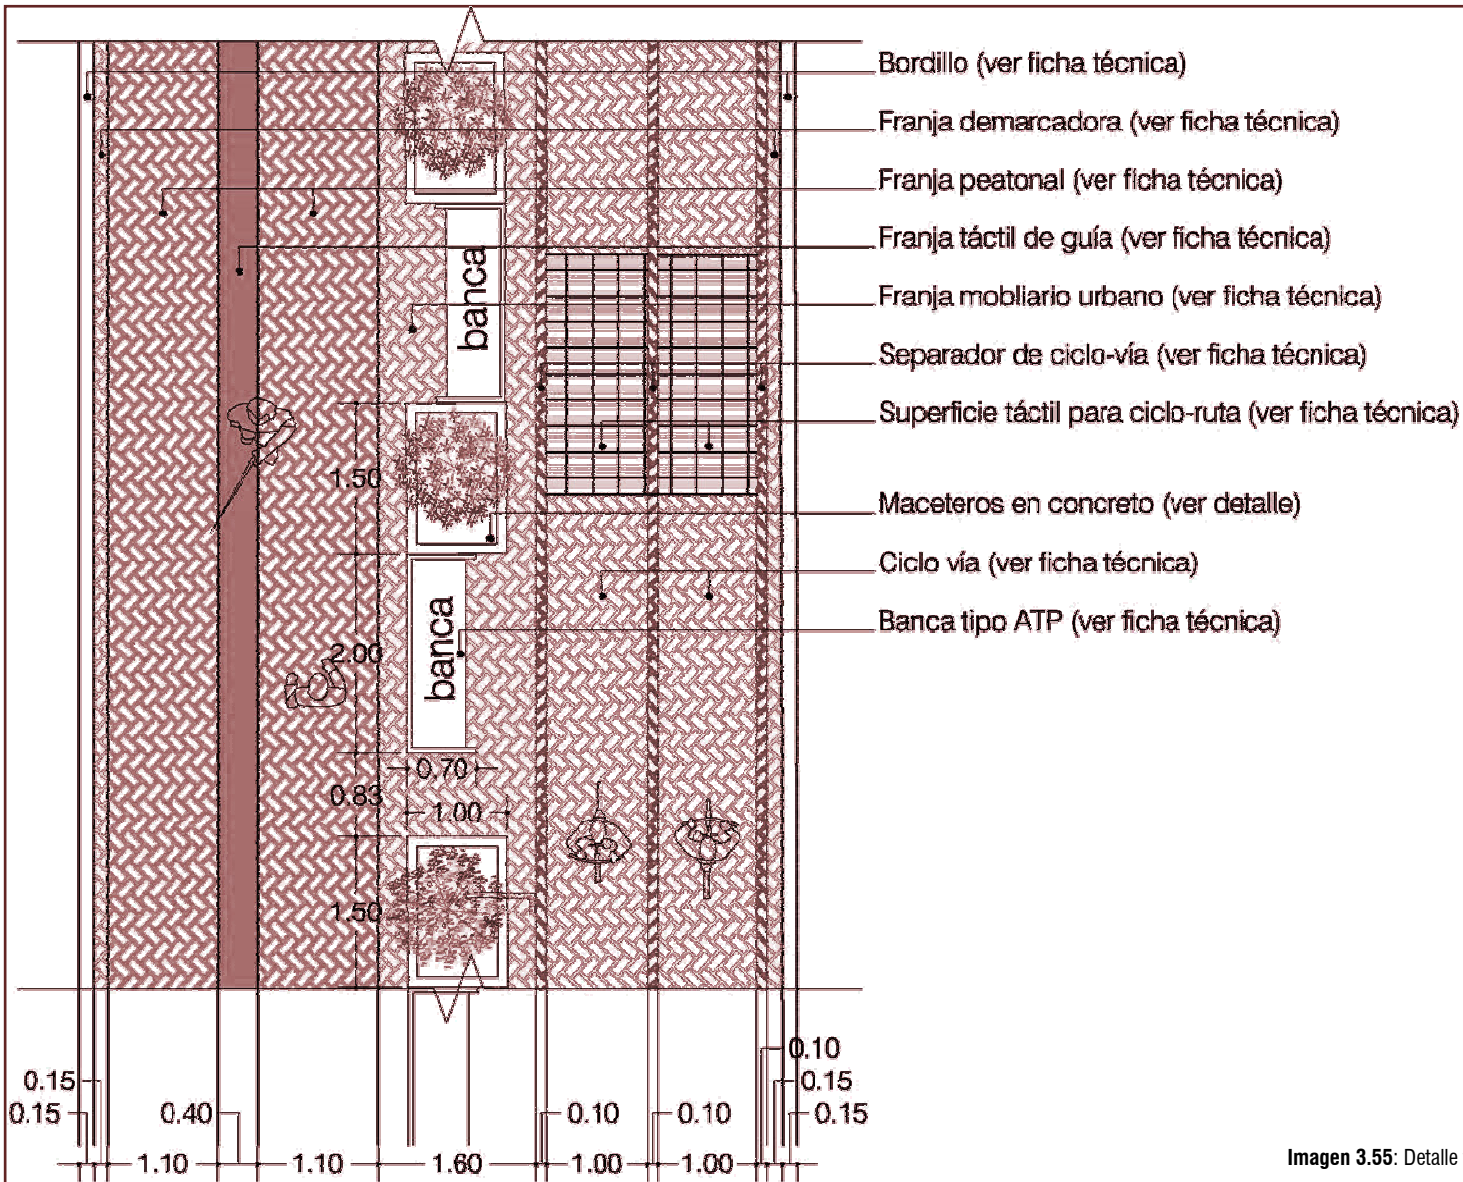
Detalle típico de acera. PLANTA.. esca la 1:75
